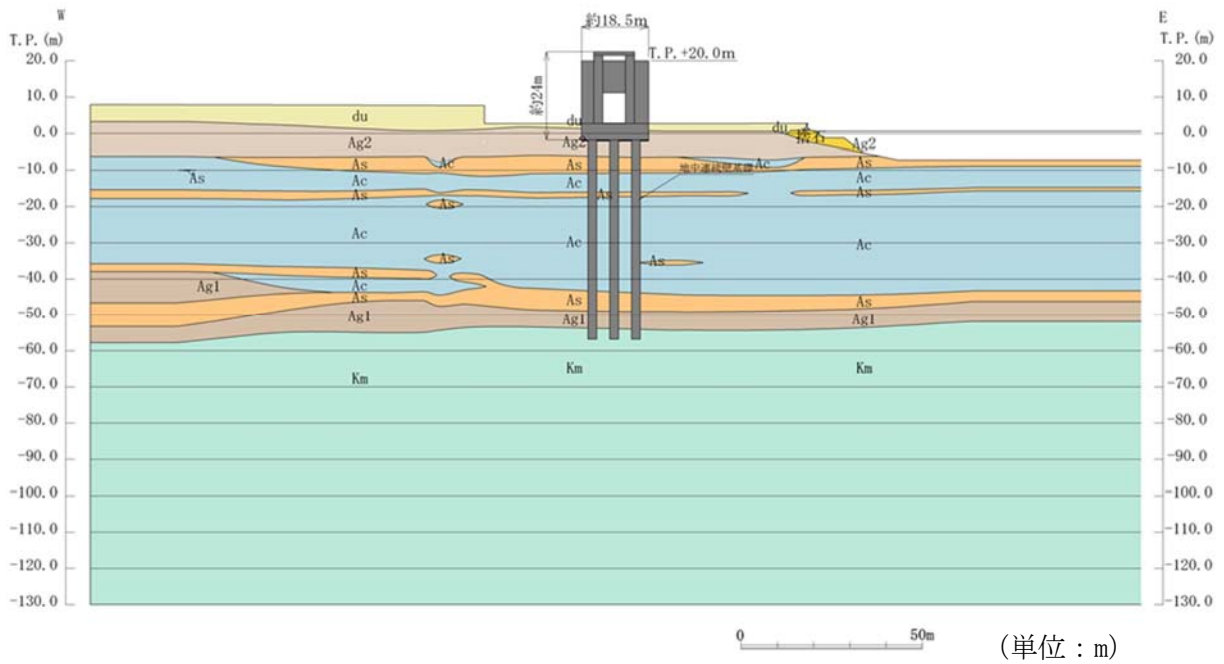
(2) 鉄筋コンクリート防潮壁 評価対象断面図 (②-②断面)
